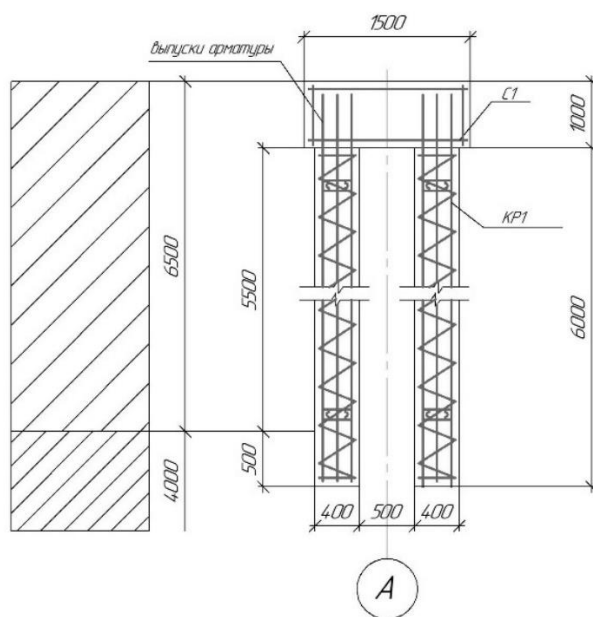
Схема свайного кустового фундамента в разрезе
